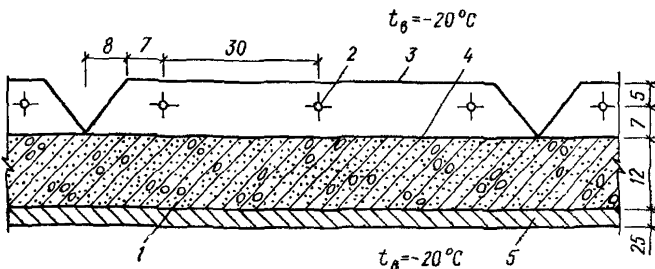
Схема к расчету и конструированию инфракрасной установки для обогрева плиты перекрытия
